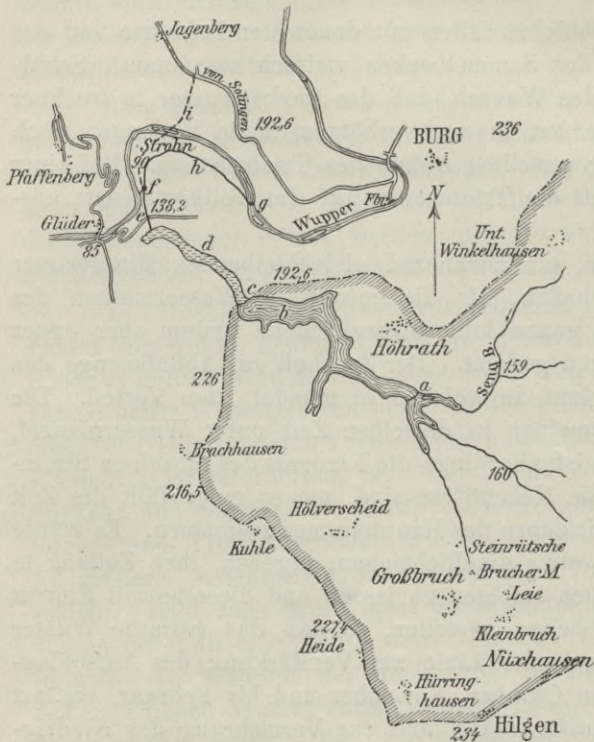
Lageplan der Talsperren- und Wasserkraftanlage der Stadt Solingen. Ungef. Maßstab 1 : 50 000.
